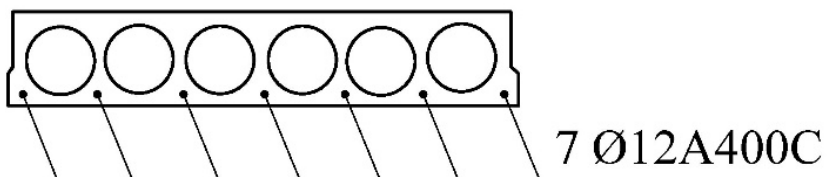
Армування нижньої зони багатопорожнистої плити перекриття
